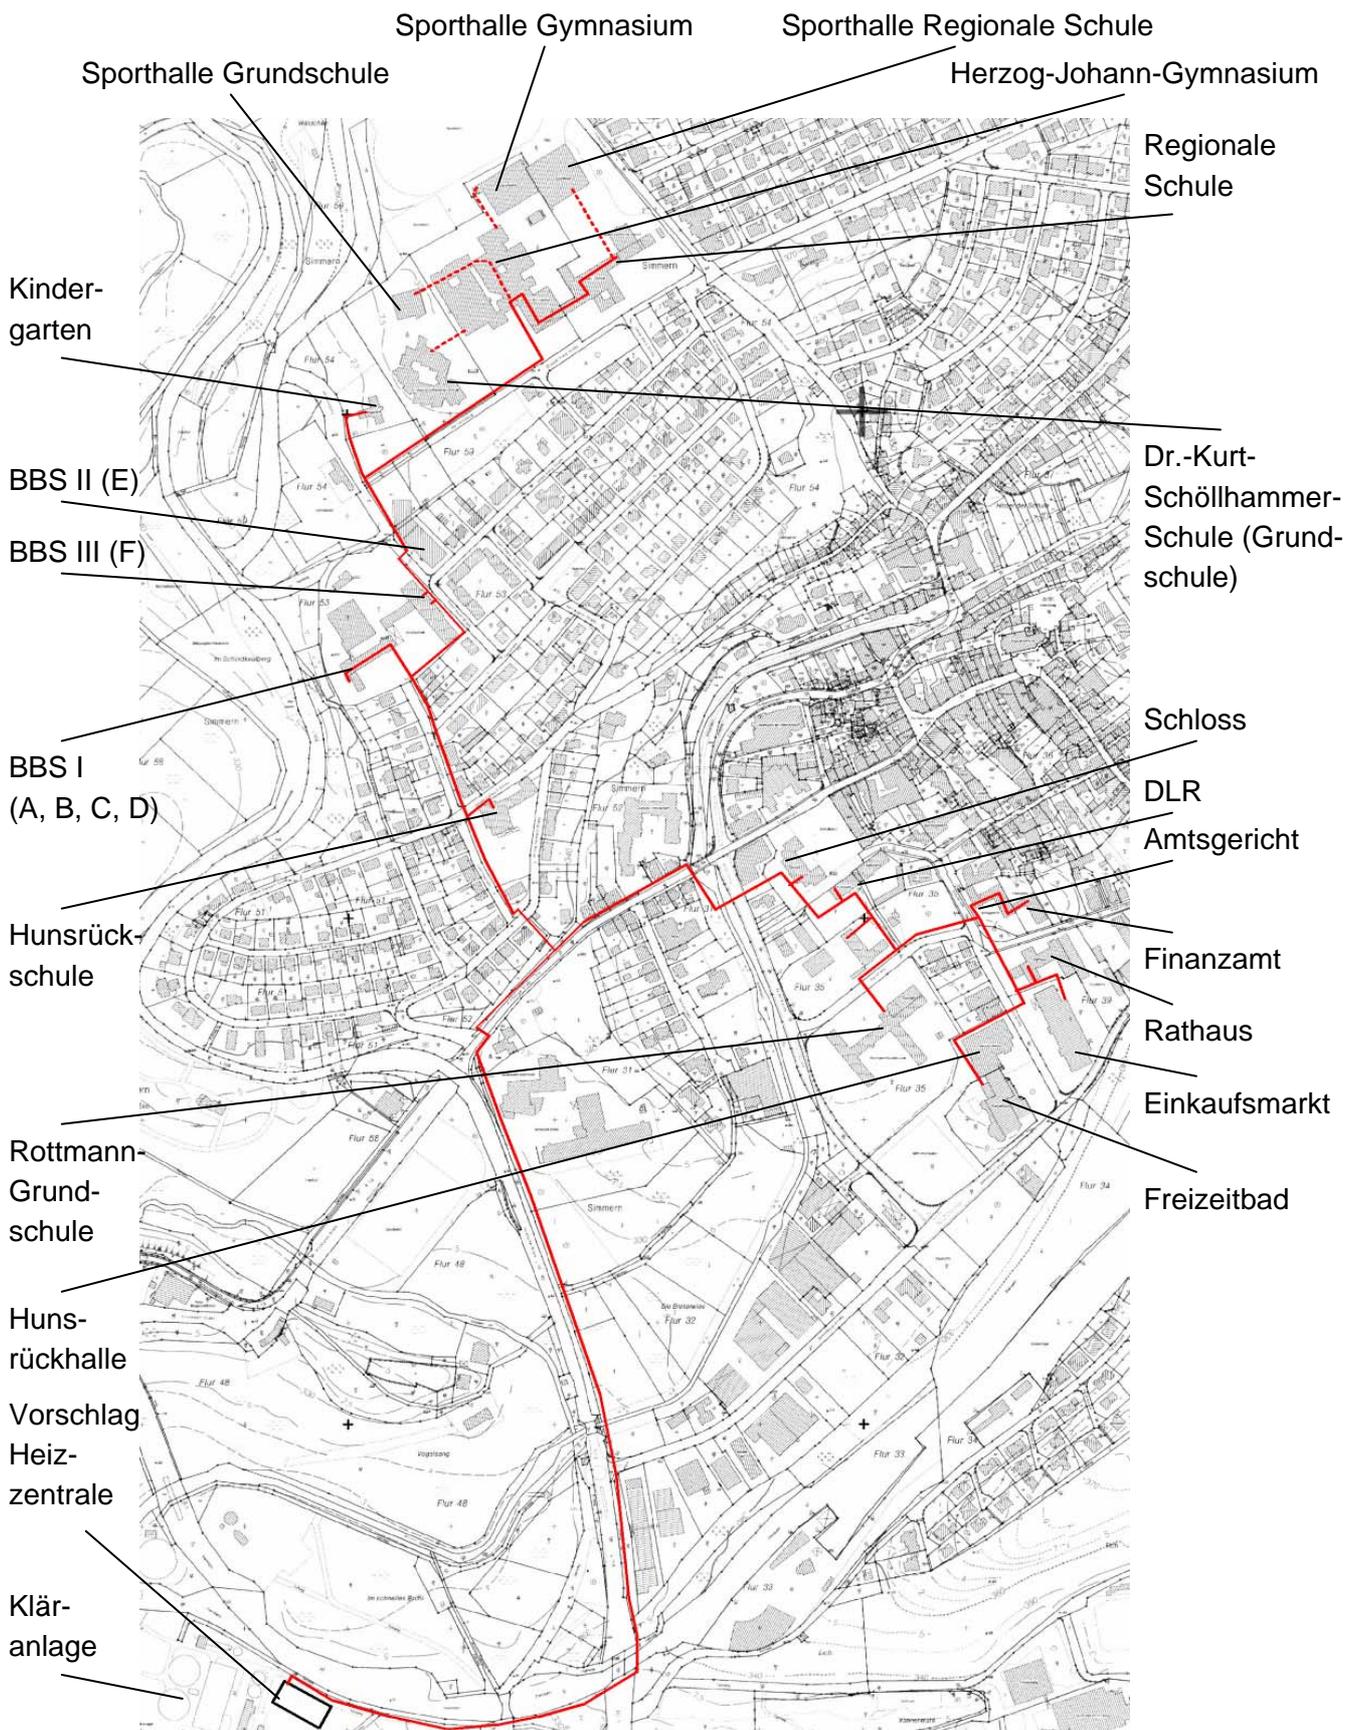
Lageplan mit Vorschlag Trassenführung Nahwärmenetz
